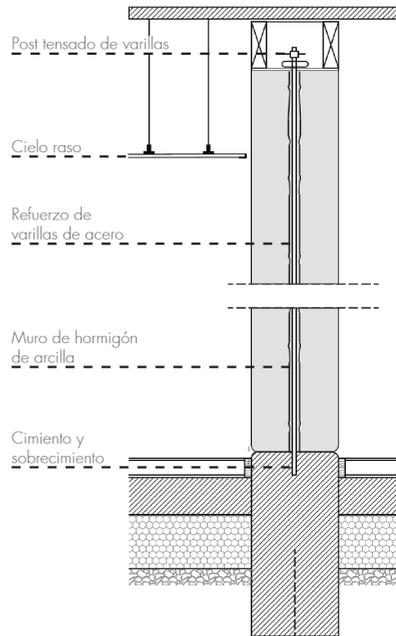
| Detalle de tabique de hormigón de arcilla construido en 2018 para el proyecto Groupe scolaire Paul-Bayrou à Saint-Antonin-Noble-Val, Tarnet. | Fuente: Autoría Propia (2024).
